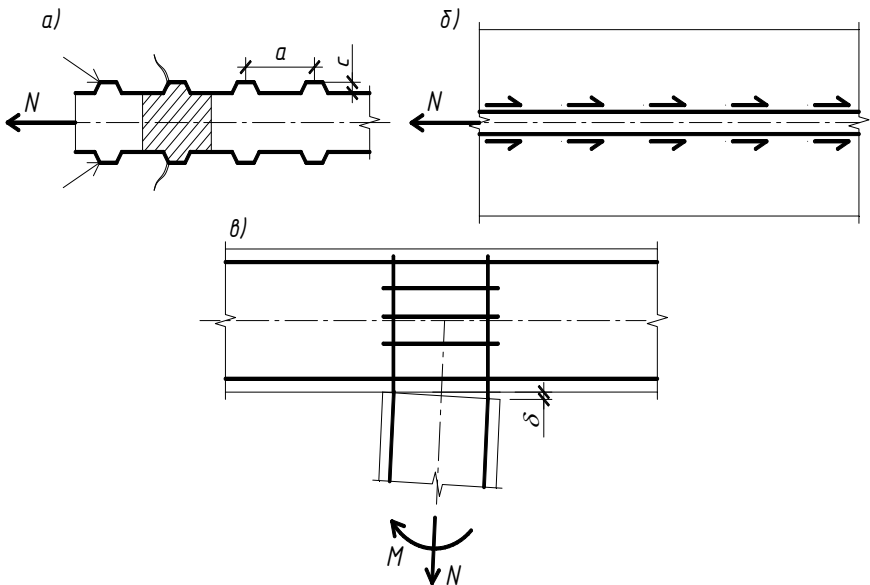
До схем моделей зчеплення арматури з бетоном за масштабом:
